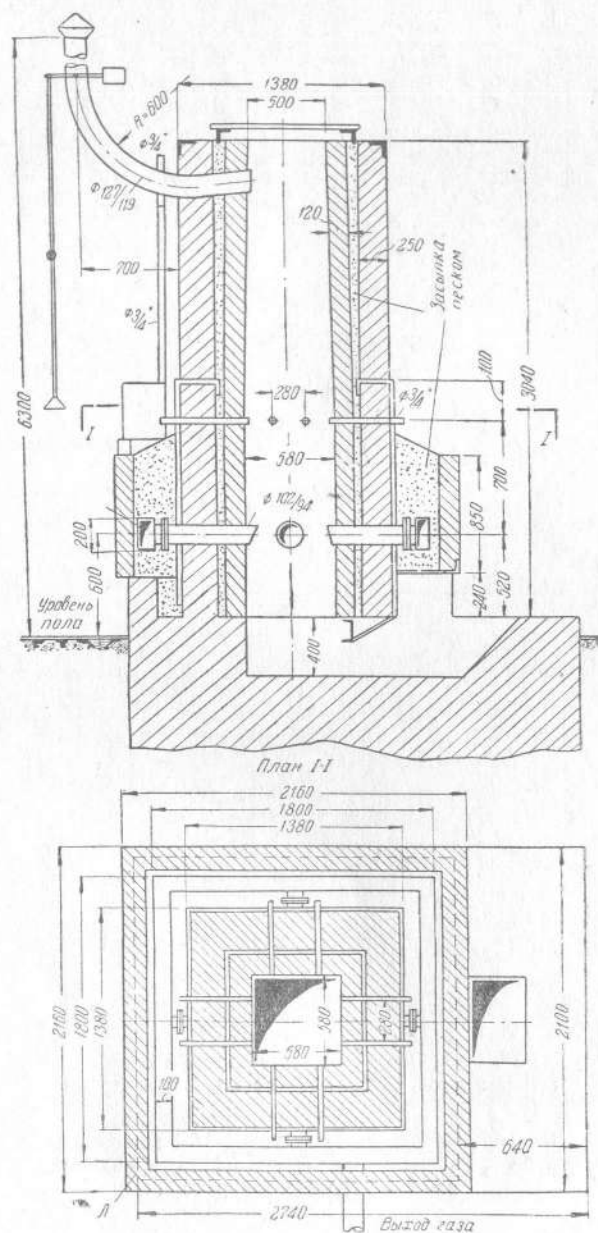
Исполнительный чертеж газогенератора „ГИХА-2“
